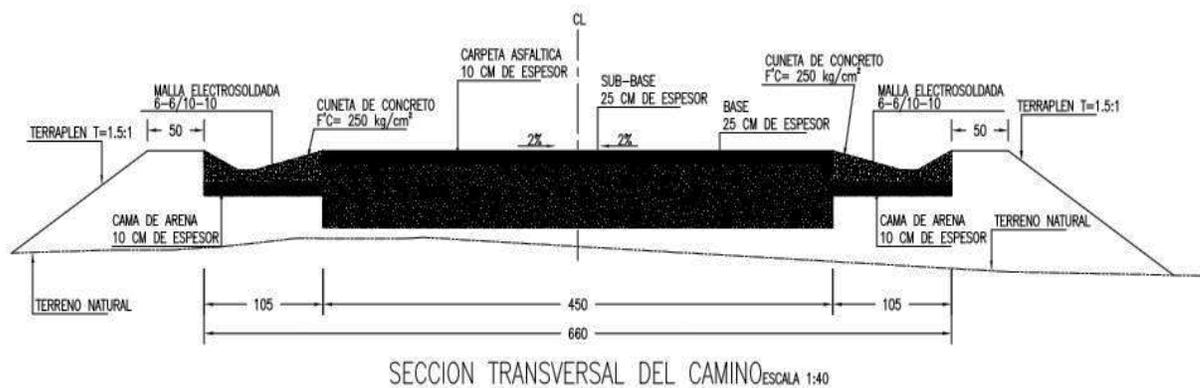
Corte Transversal del Camino de Acceso al Muelle.
